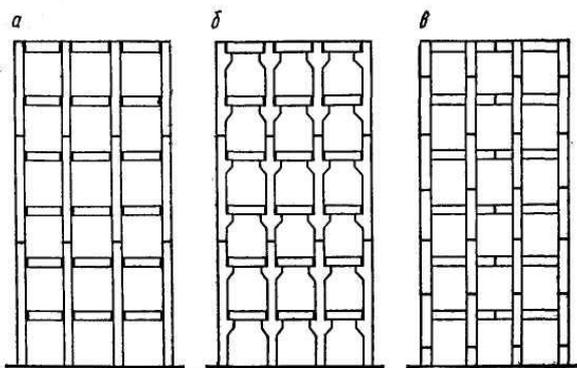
Конструктивные схемы членения многоэтажных рам на сборные элементы
